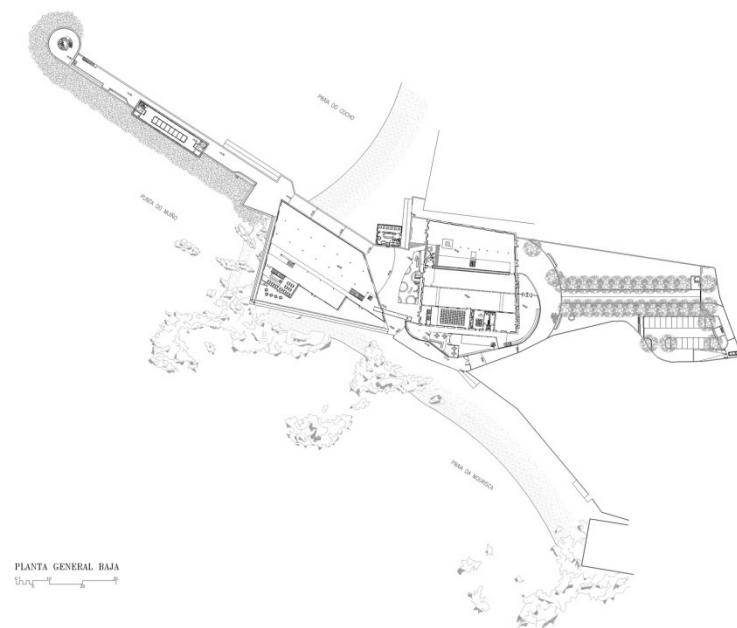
1 Museo do mar de Vigo. Planta xeral do conxunto.
